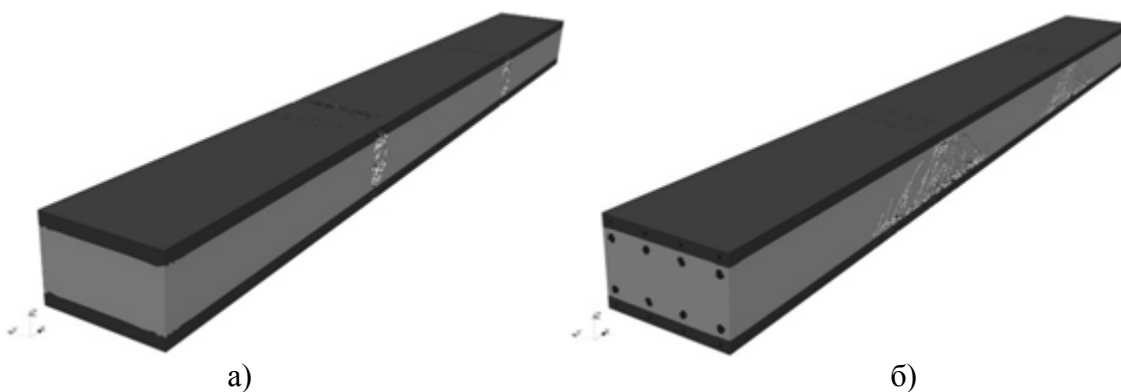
Разрушение балки без армирования (а) и балки с арматурой (б). $t=3$ мс.
